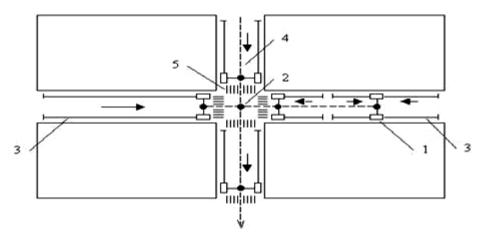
Схема размещения дождеприемников 1 – дождеприемники, 2 – колодцы, 3 – лотки, 4 – закрытые трубопроводы, 5 – пешеходный переход
